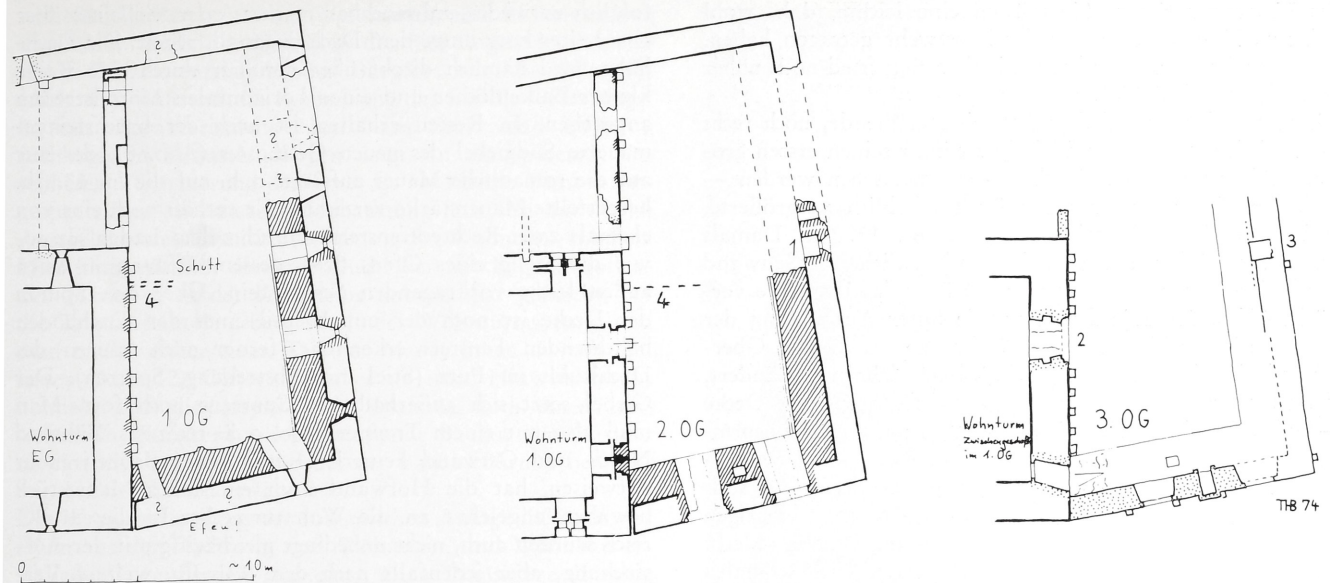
Rathsamhausen, Grundrisse des Wohnbaues (Erdgeschoß vgl. Gesamtgrundriß)
